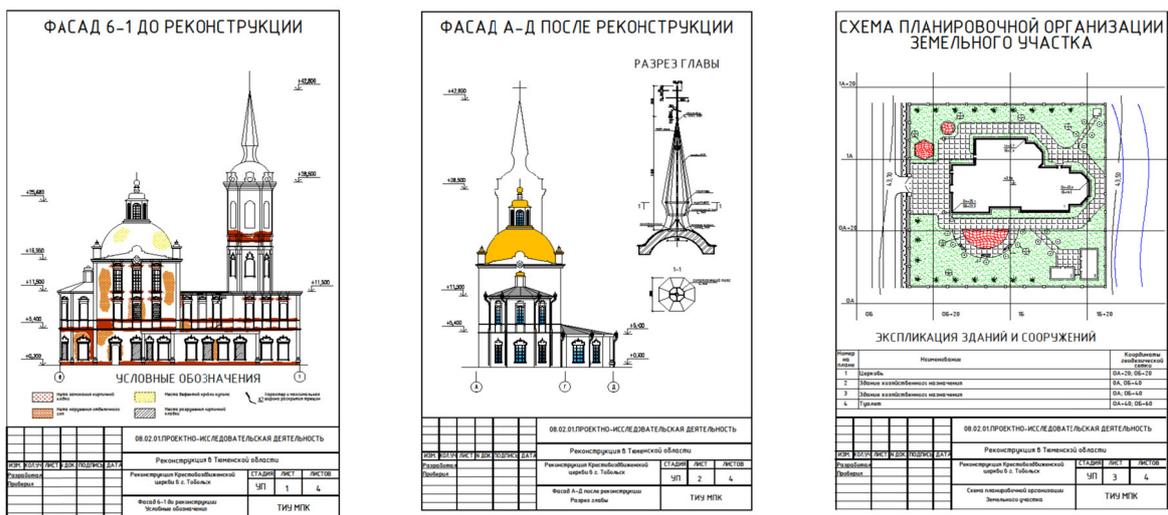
Чертежи графической части исследовательской работы по реконструкции Крестовоздвиженской церкви
